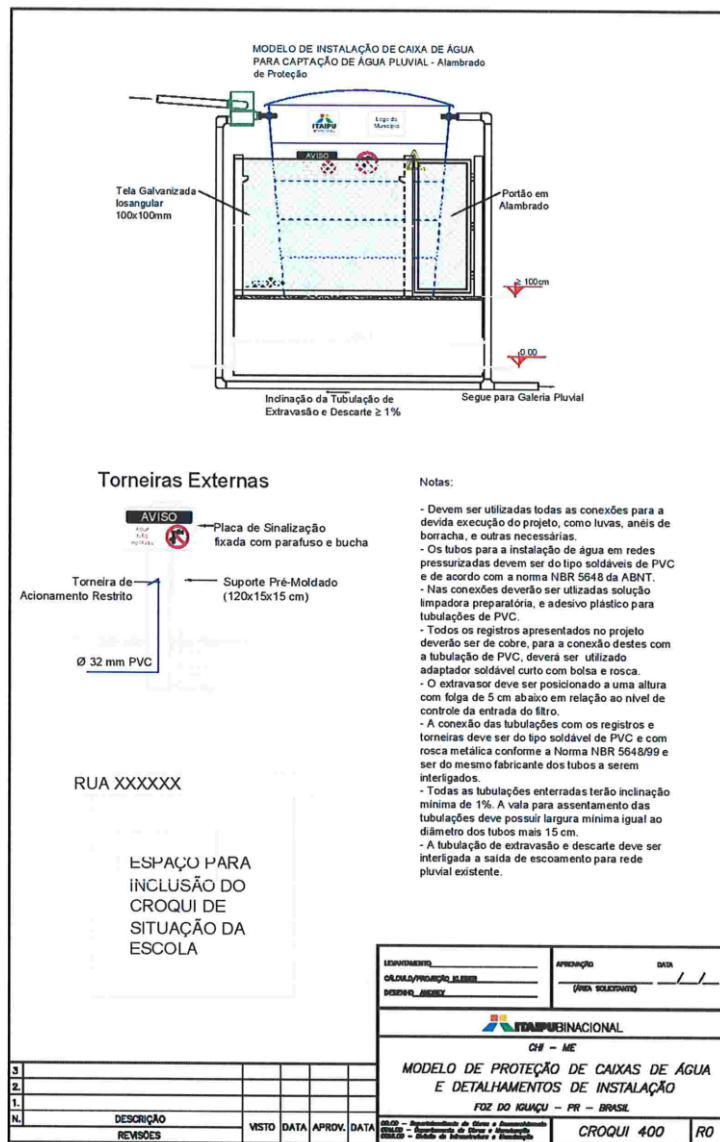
Modelo de referência de isolamento e detalhamento de instalação
